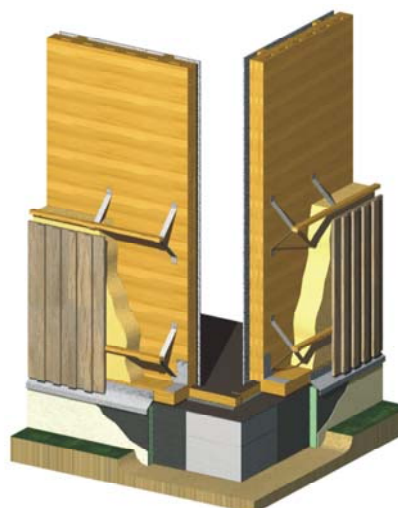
Montaggio di un elemento preassemblato (sin.) e fissaggio di elementi di isolamento e di facciata (des.)
